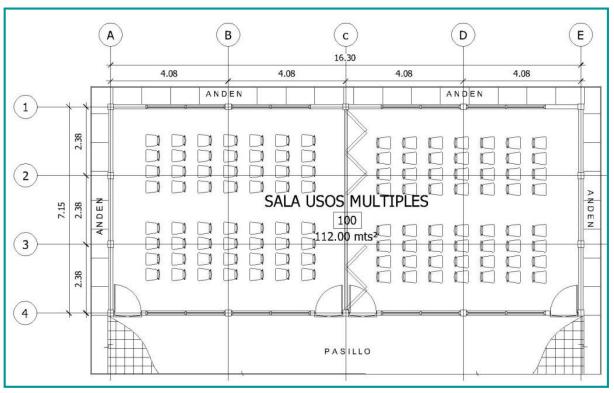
Planta arquitectónica de salón de usos múltiples
